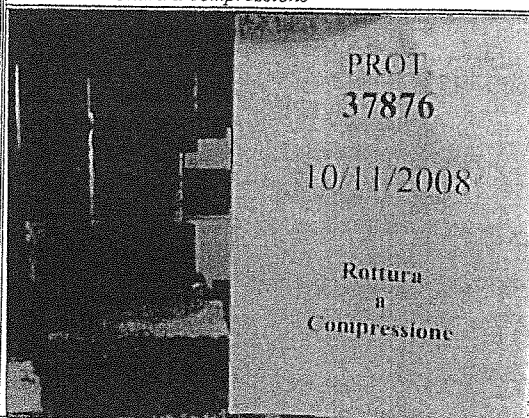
Vista della carota (P2) durante la prova di rottura a compressione
